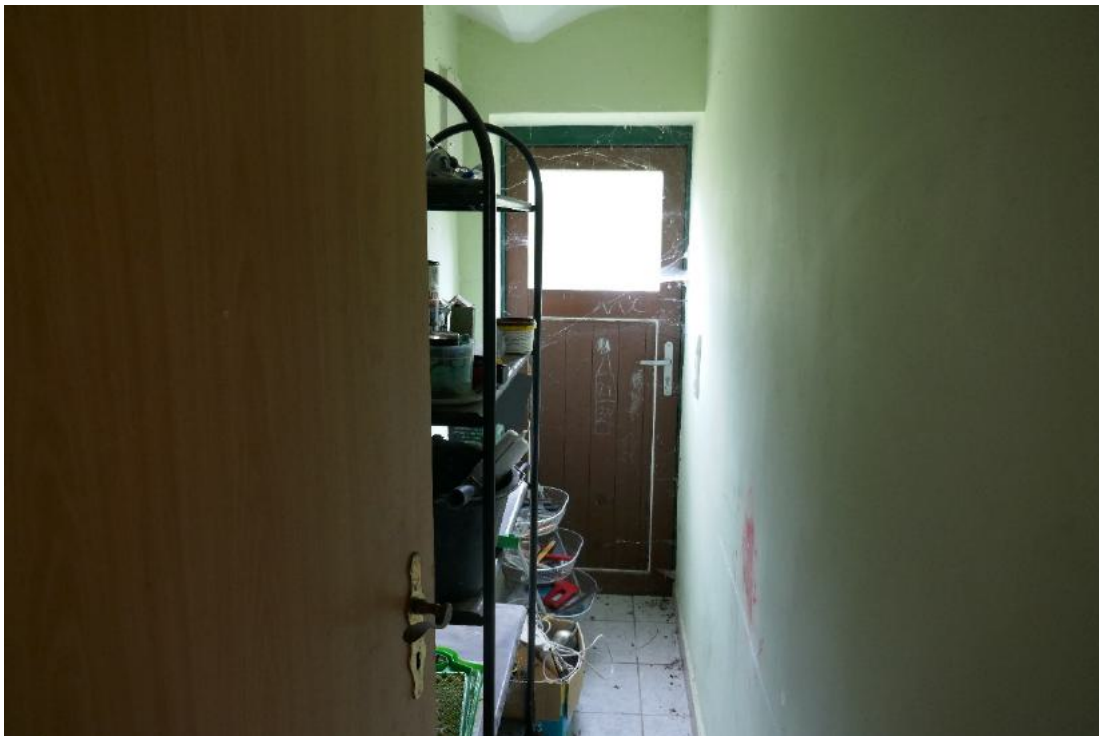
, EG zweiter Flur, erschließt Hauswirtschaftsraum, Blick zur Haustür
